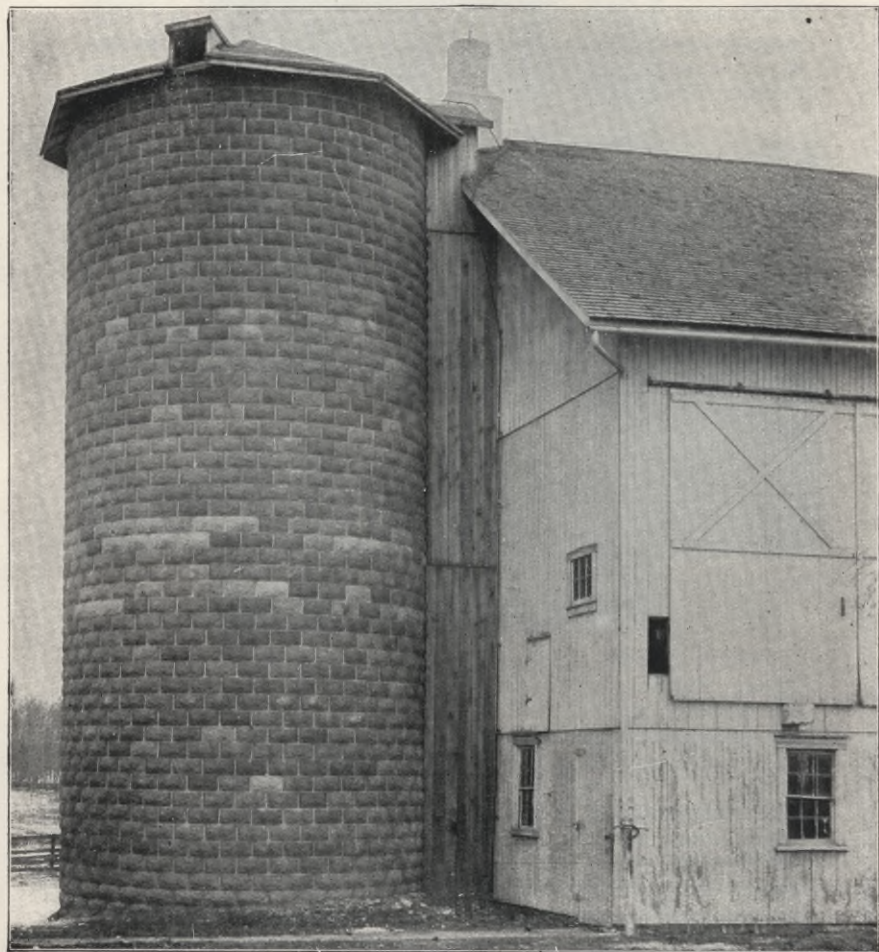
Grünfuttersilo aus Betonhohlblöcken.
